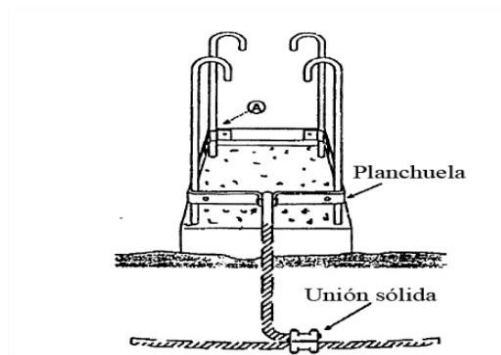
Equipotencialización del acero estructural con la malla de tierra.
